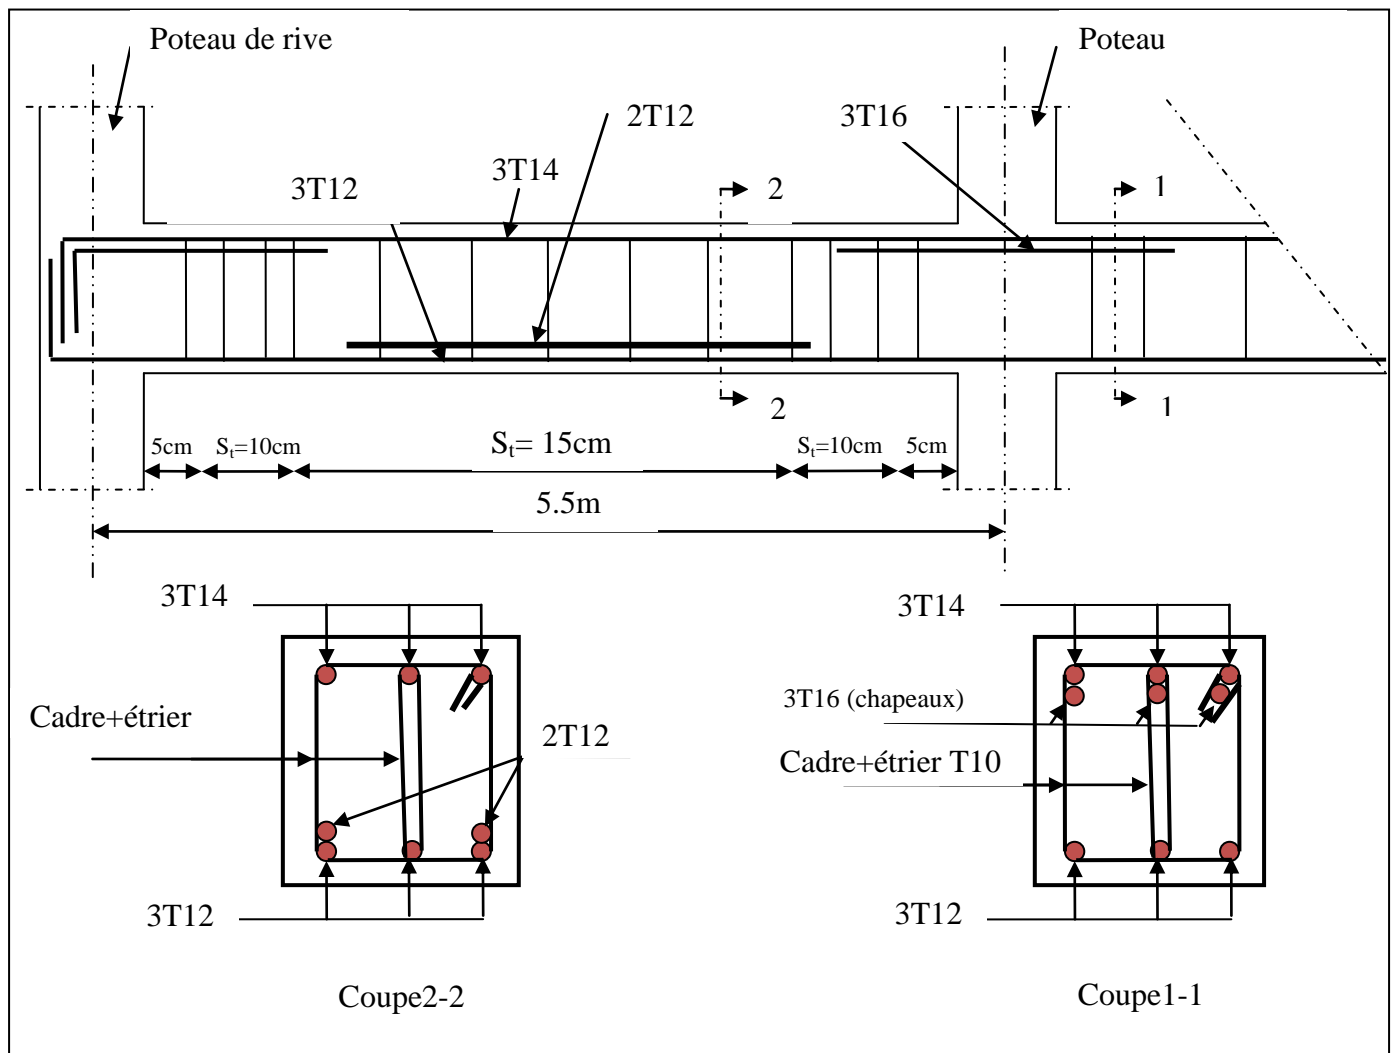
Schéma de ferrailage de la poutres principale du RDC.
